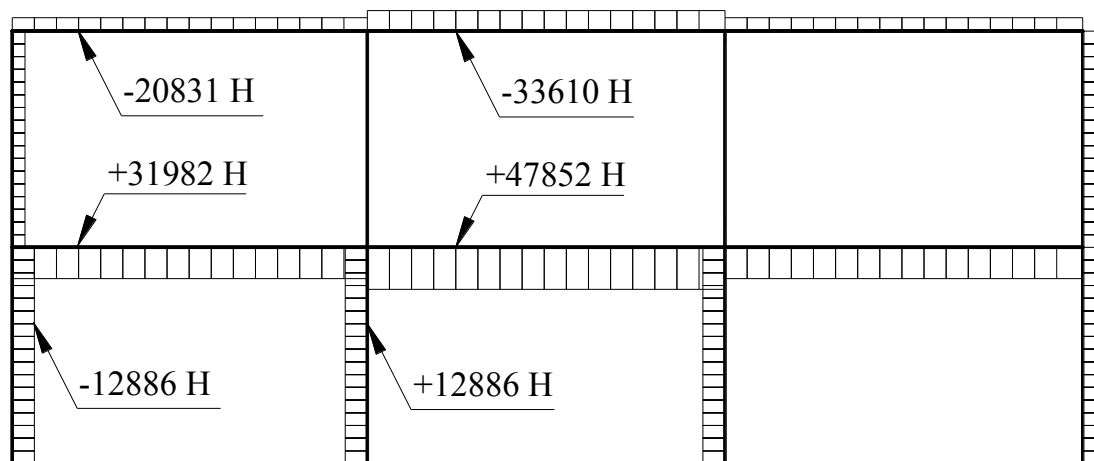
Эпюра продольных сил для 3 Варианта тепловой нагрузки
